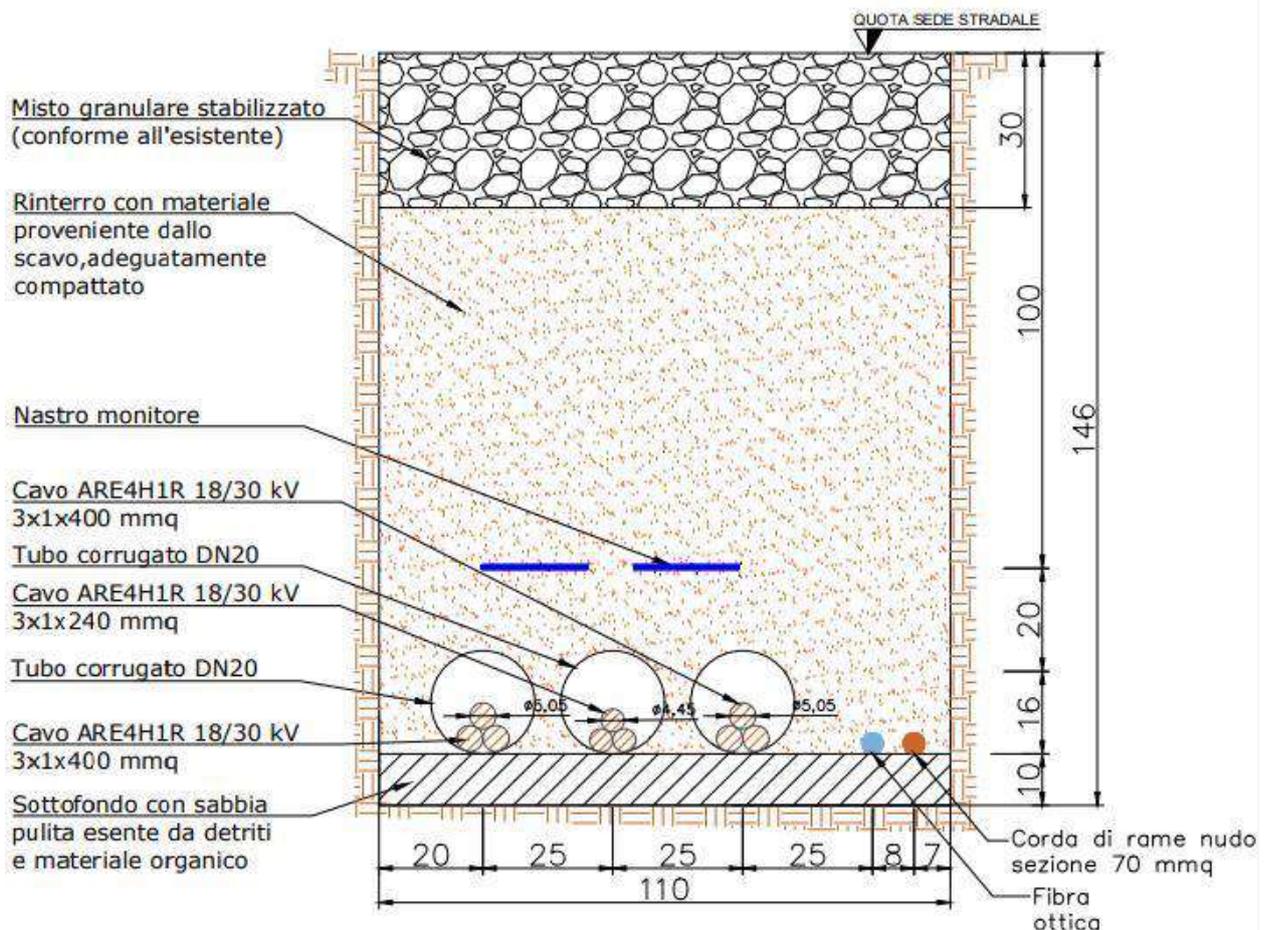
Sezione cavidotto MT composto da tre terne di cavi a 30 kV su strada asfaltata
